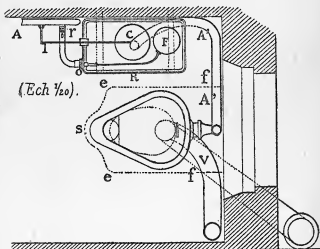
Plan d'installation complète d'un cabinet salubre.
